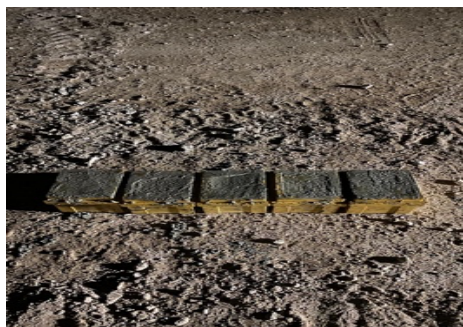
Pruebas de hormigón Fuente: RING 8
